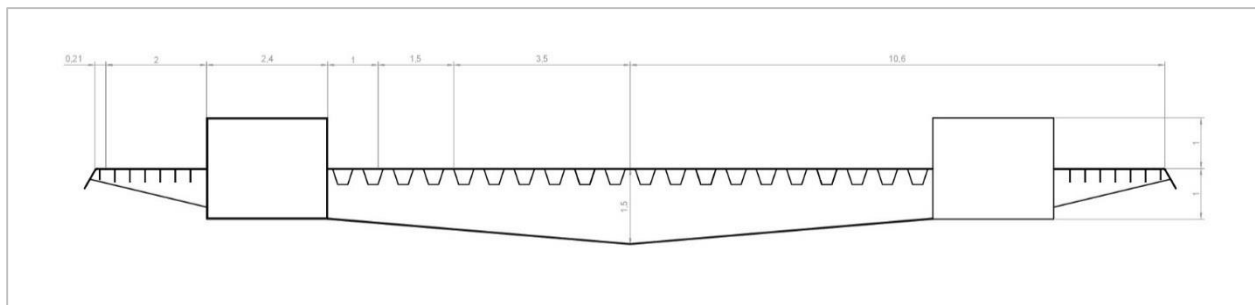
2. Alternativa n°1 – Tablero móvil de acero / Alternativa n° 2 – Tablero completo de acero.
